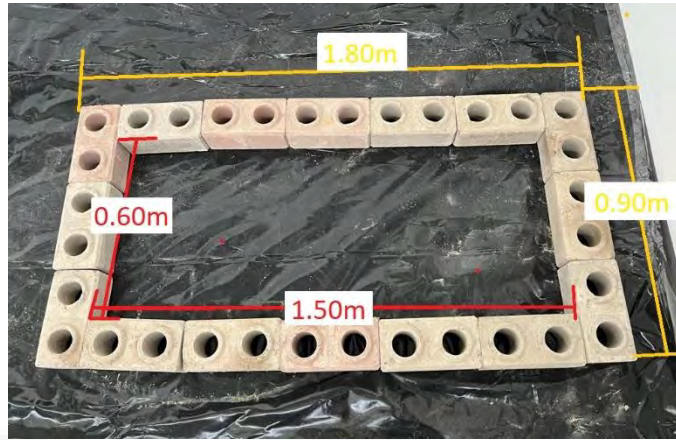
base de la cuneta, montado con block de concreto hueco. Imagen del autor.
